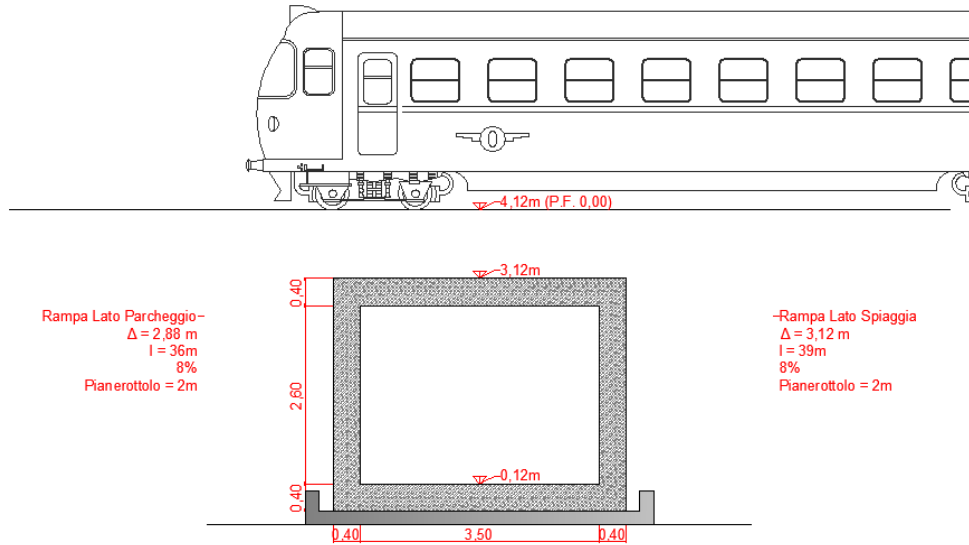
Sezione scatolare e rampe d'accesso del sottopassaggio ciclabile.
